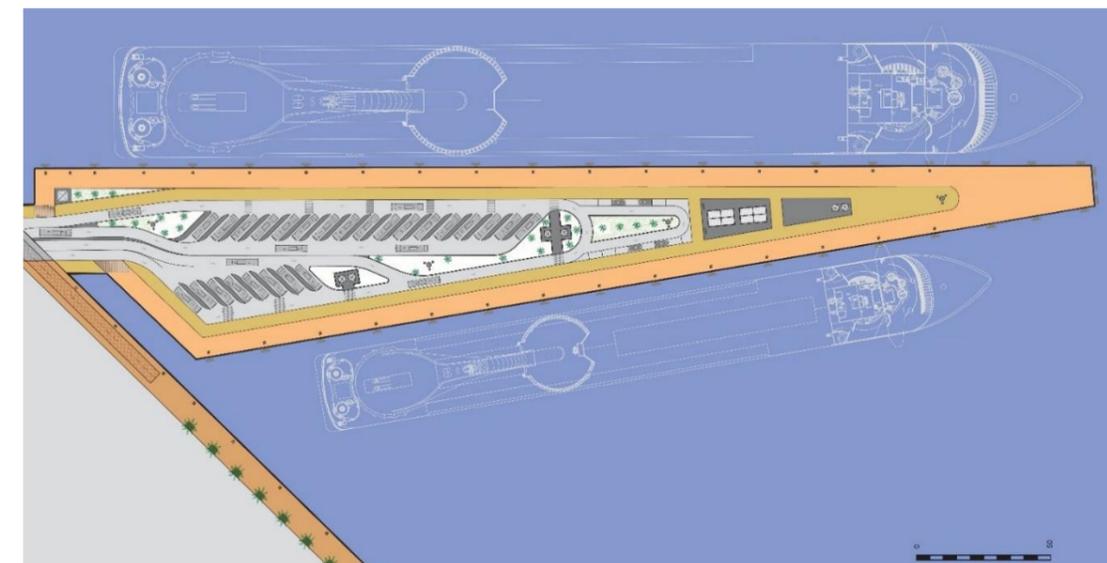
PLANIMETRIA DI PROGETTO NUOVO MOLO CROCIERE
